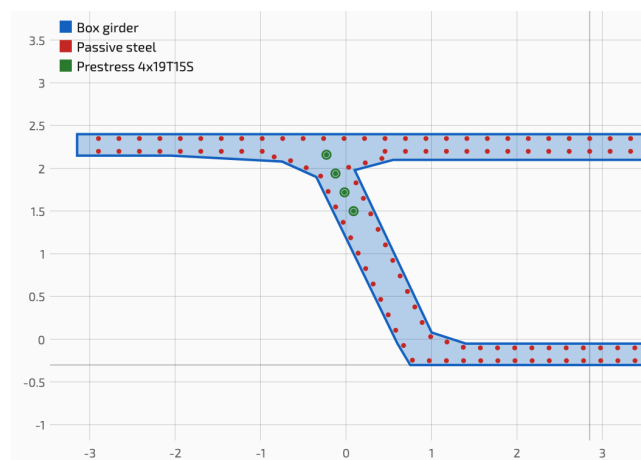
Exemplos de seções avançadas exibidas no SectionPro.
